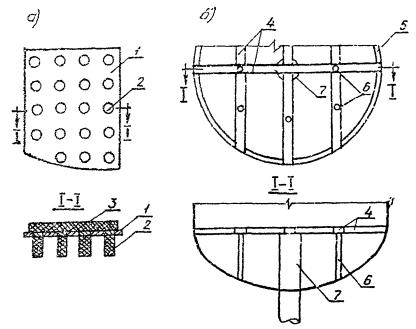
Схема конструкции дренама типа 4 фильтра заводского изготовления: а — дренажная плита; б — опорная конструкция; І — металлическая дирчатая плита; 2 — патрубки; 3 — слой полимероетона; 4 — горизонтальные продольные и поперечные опоры; 5 — периферийные опоры; 6 — вертикальные опоры—стойки; 7 — центральная опора
